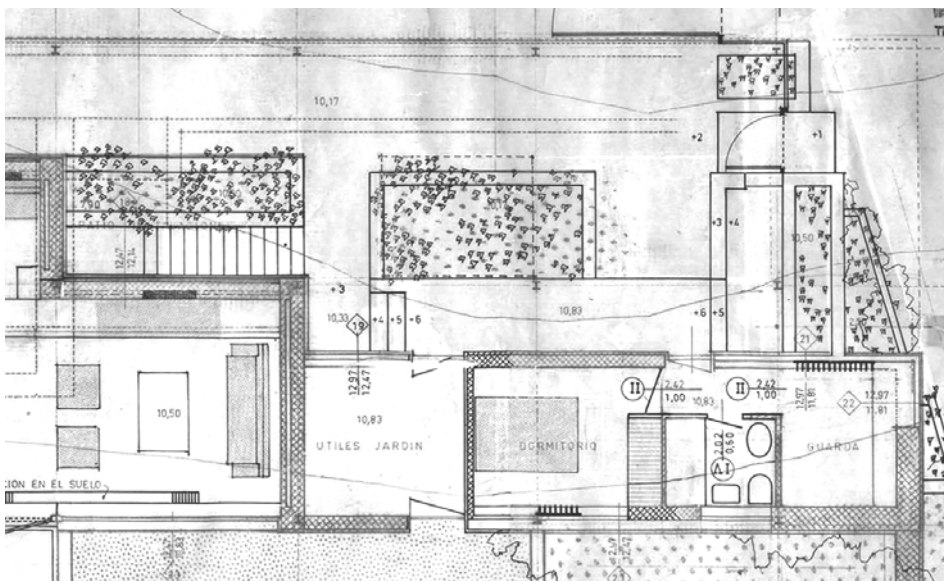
Planta. Casa del guarda a la derecha. El cuarto de jardinería adosado permite el paso directo desde la entrada al patio de relación. A la izquierda se observa las escaleras de bajada a la galería de instalaciones. Plano: Legado Vázquez Molezún Fundación COAM
